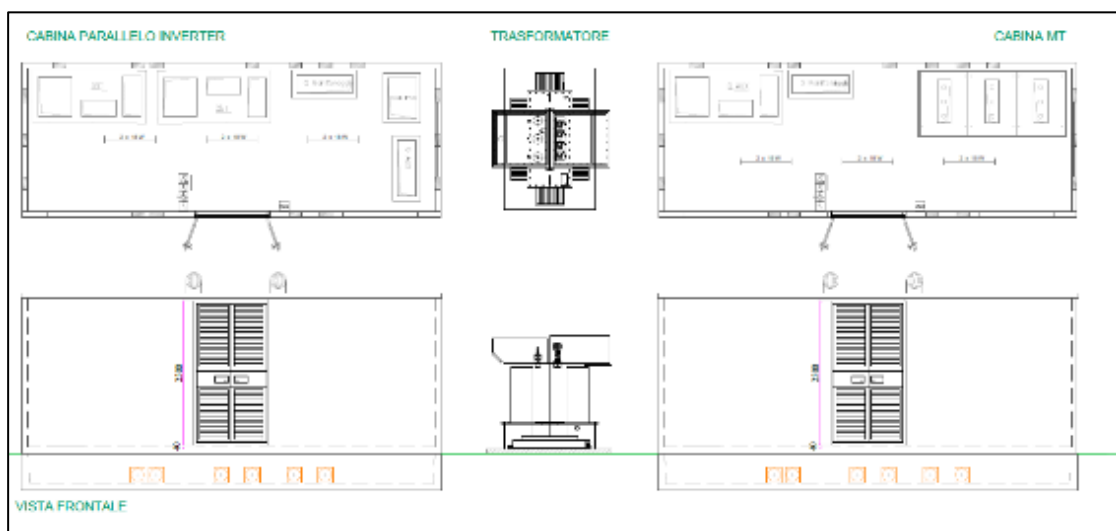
Power Station – Pianta e Prospetto (GAV20\_021800\_IMP\_D\_Architettura\_Locali\_e\_Cabine\_elettriche)
